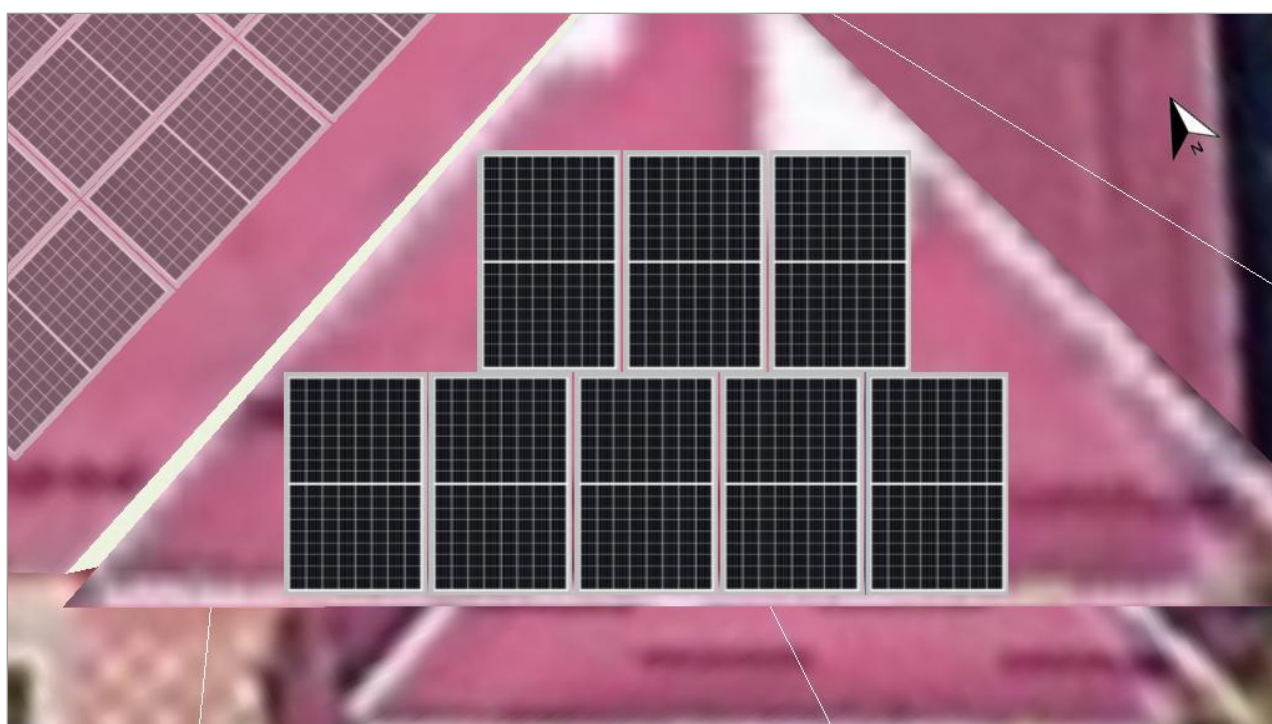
Zona modulului - Arbitrary Building 02-Mounting Surface Southwest
